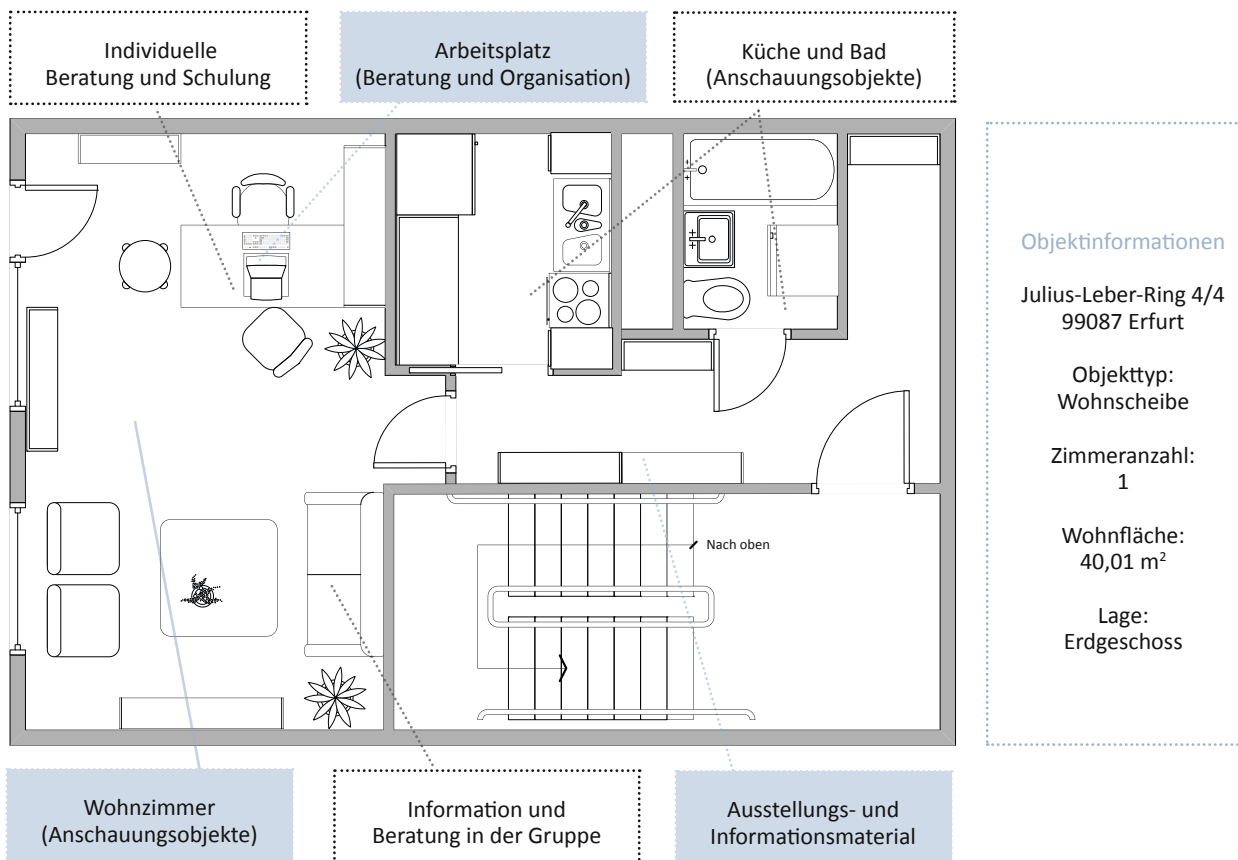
Grundriss der Modellwohnung im Erfurter Stadtteil Roter Berg (Quelle: eigene Darstellung 2018)
